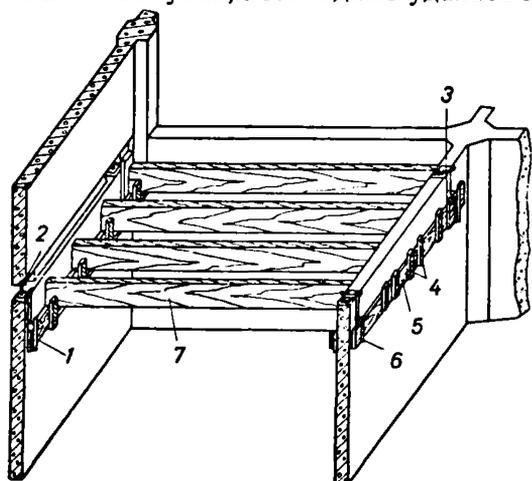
Схема устройства опалубки перекрытия при возведении башенного копра в скользящей опалубке:
